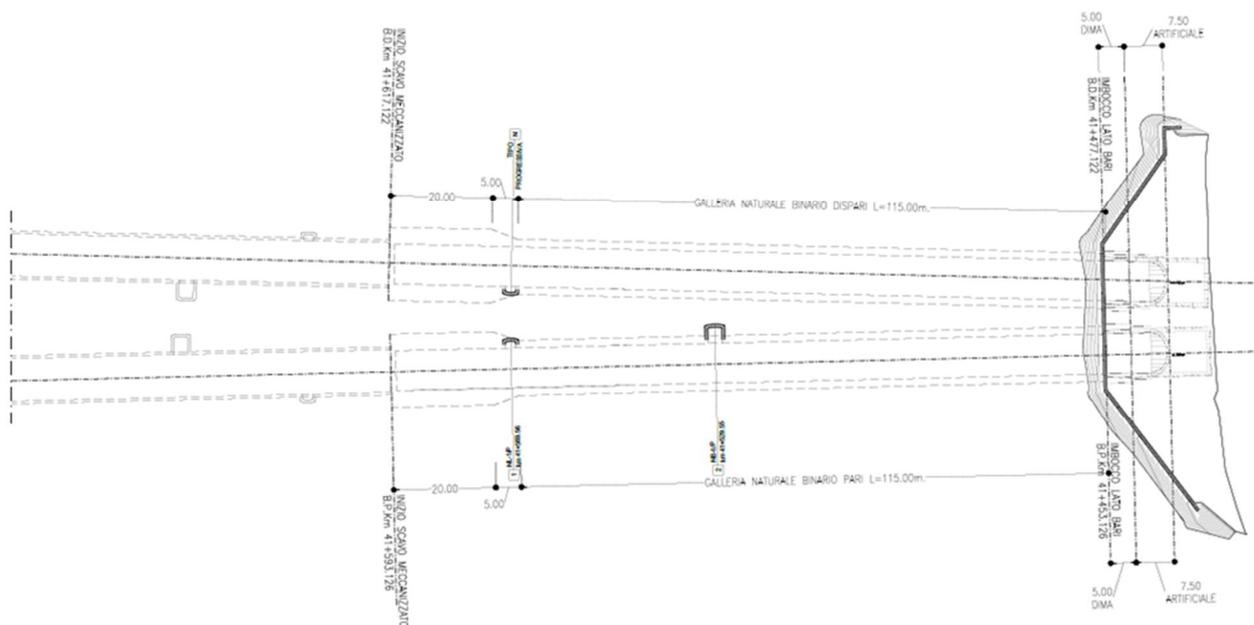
planimetria generale tratta in tradizionale lato Bari
